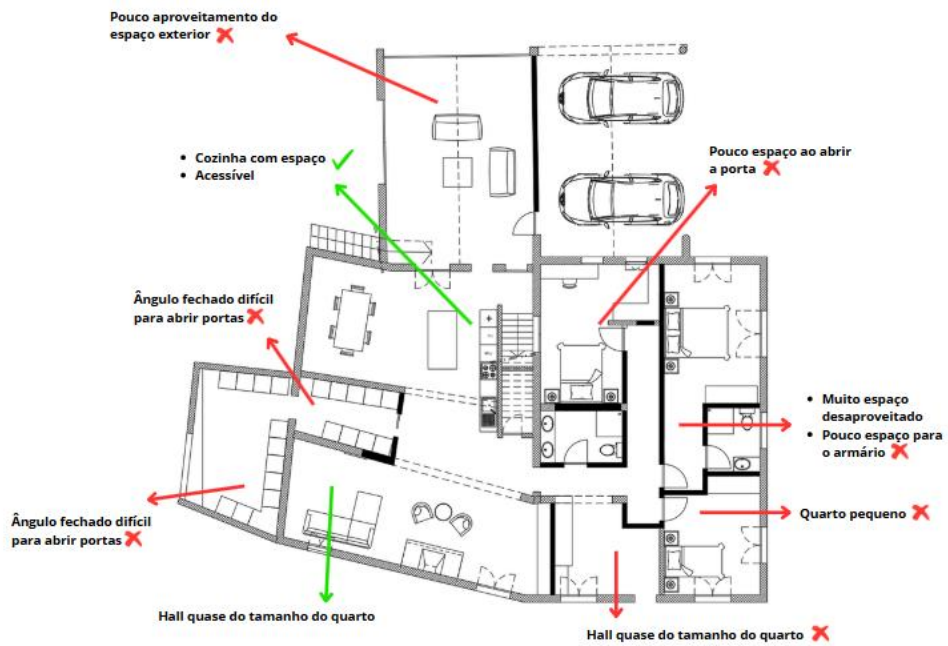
Análise de plantas esboço, proposta 2, piso 0
